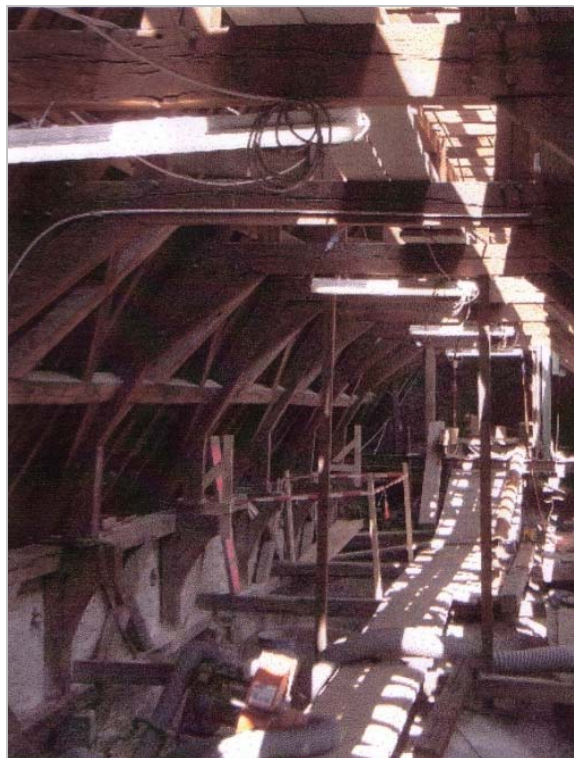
Vue de l'intérieur des combles au début du chantier et la nécessité de faire de cet espace, un espace de travail avec des planches posées pour ne pas surcharger les voûtes et l'éclairage artificiel nécessaire. (Janssen, 2009)
